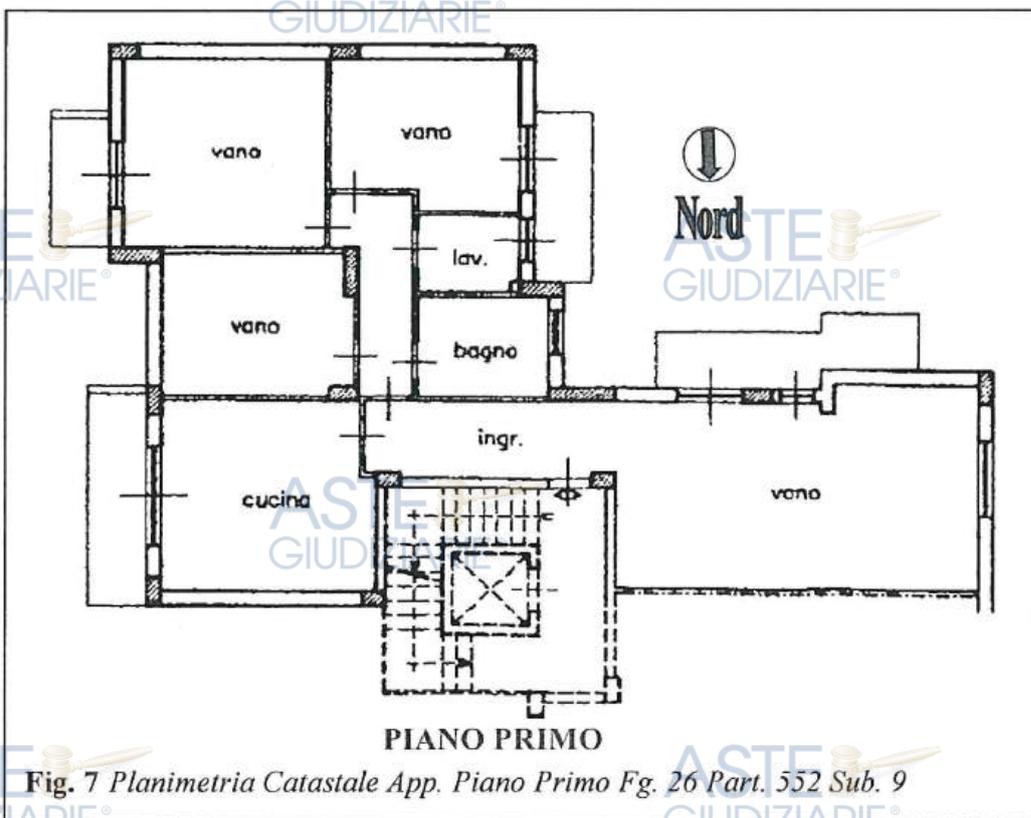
Planimetria Catastale App. Piano Primo Fg. 26 Part. 552 Sub. 9
